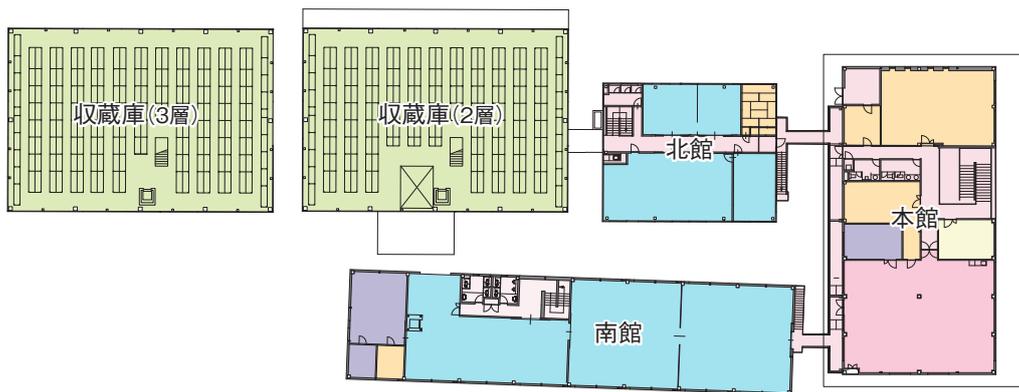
高知県立埋蔵文化財センター2F平面図(S=1/800)
